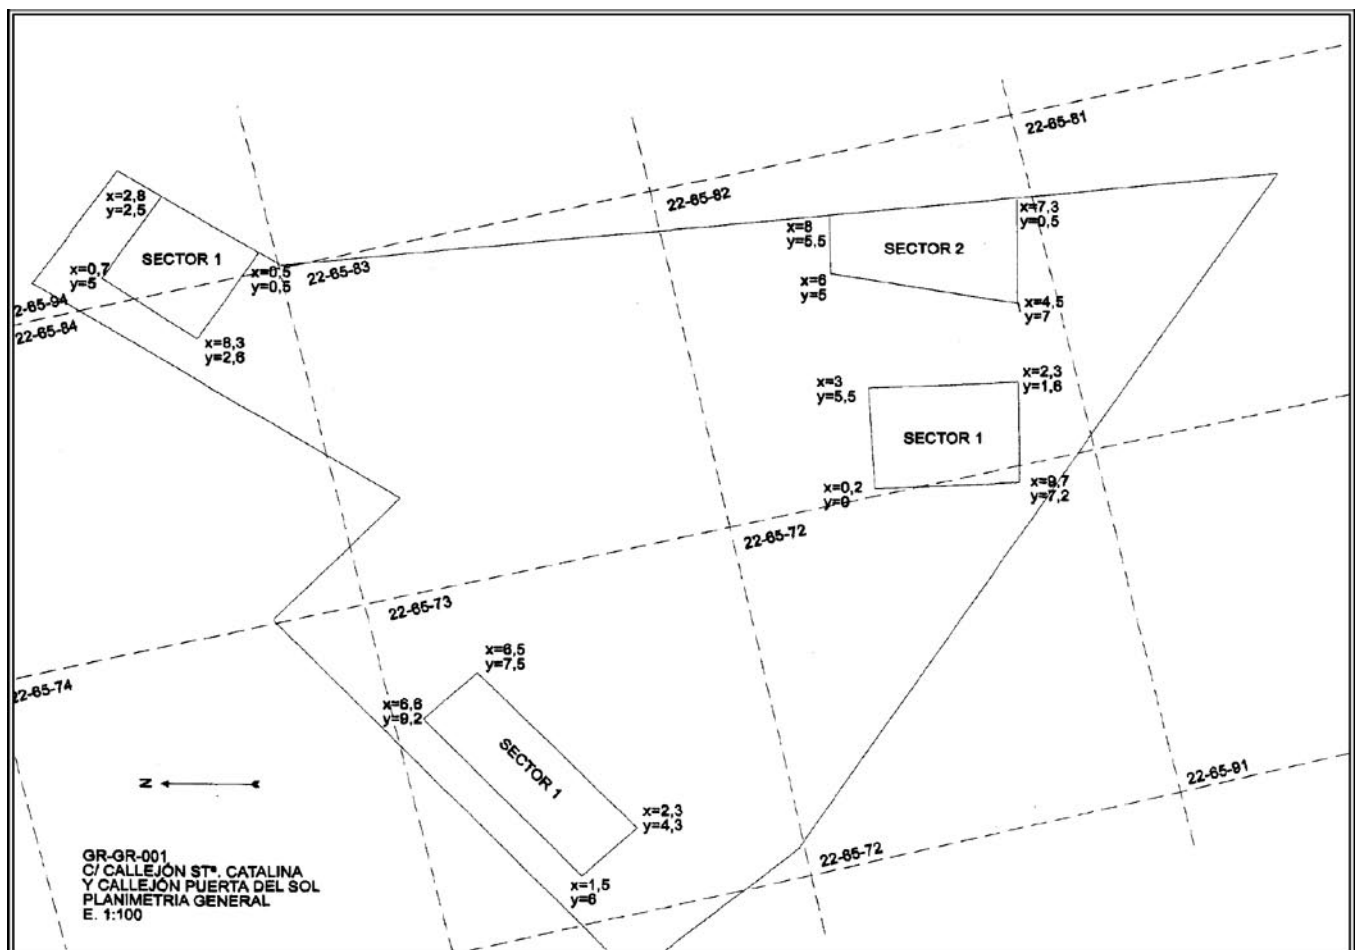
Planta General con la ubicación y dimensiones definitivas de los sectores a intervenir.
